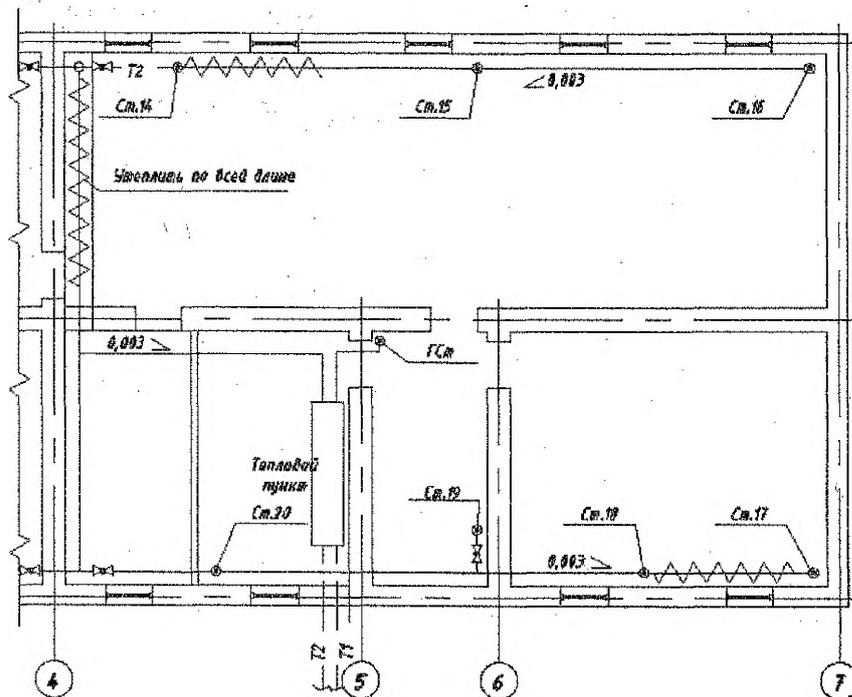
Пример расположения элементов системы отопления на плане подвала
